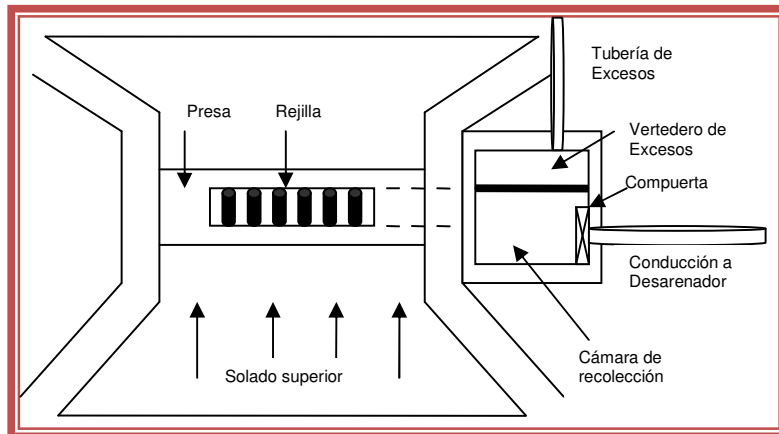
Bocatoma de fondo – Planta (adaptado por López Cualla).
